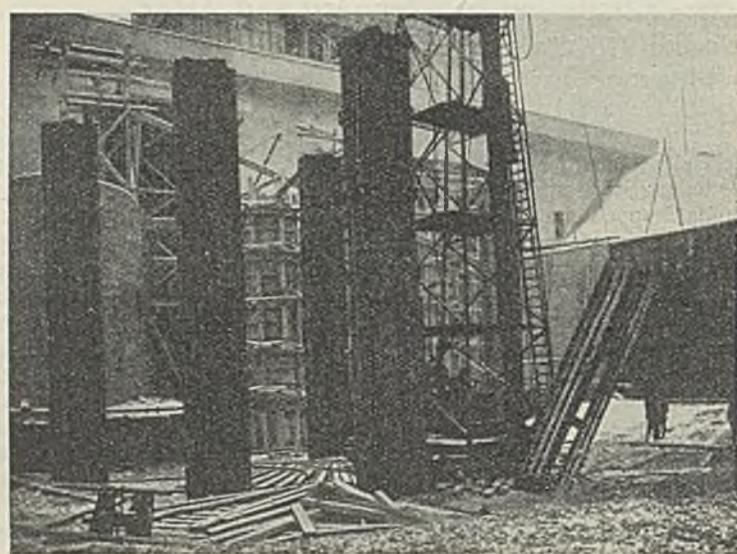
Leitwerk aus eisernen Dalben von fünfeckigem Grundriß im Bau.
